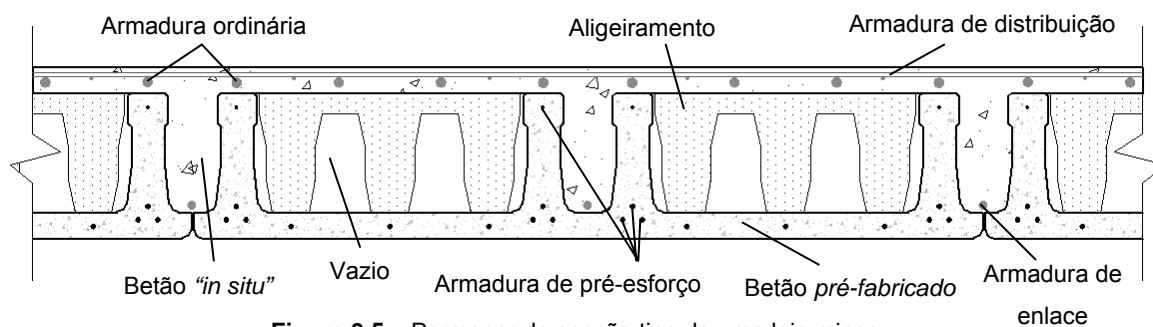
Pormenor da secção tipo de uma laje minos
